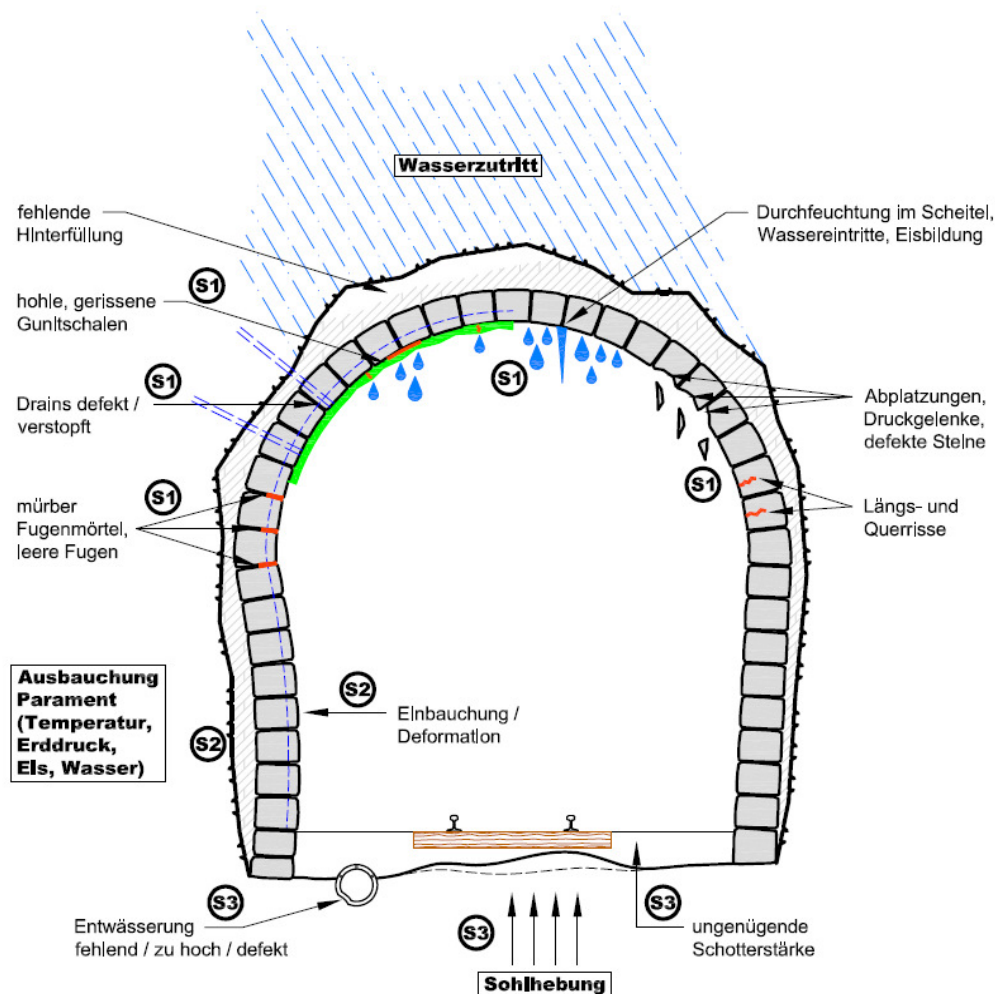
Schadenmechanismen Mauerwerkstunnels
